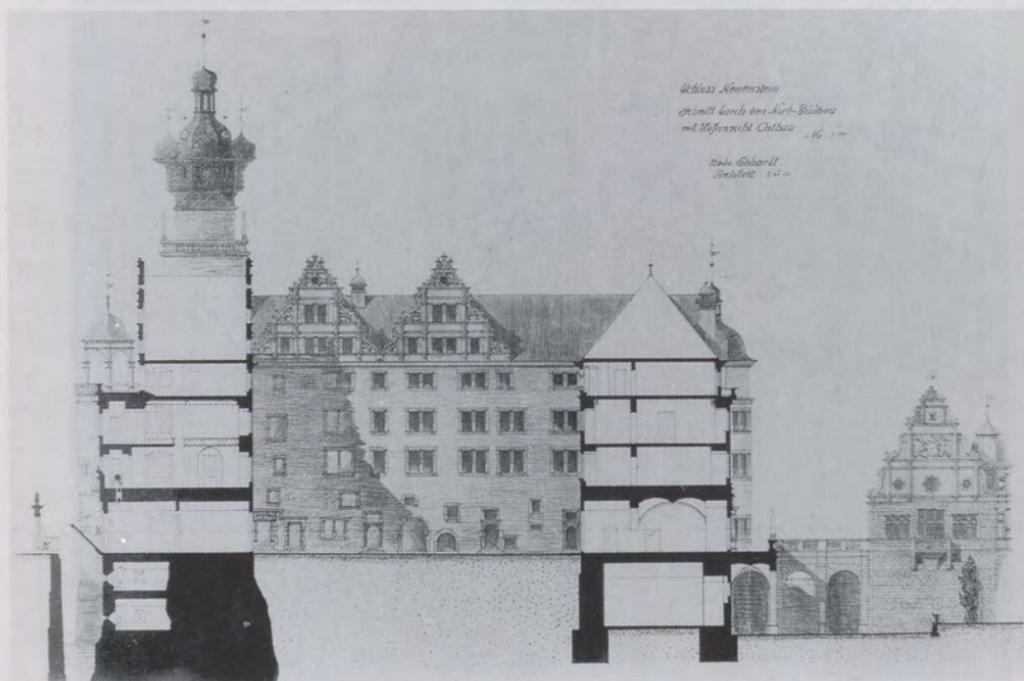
Erster Gesamtentwurf: Schnitt durch den Nord-Südbau mit Hofansicht Ostbau. (HZAN: Plan o. I.)
